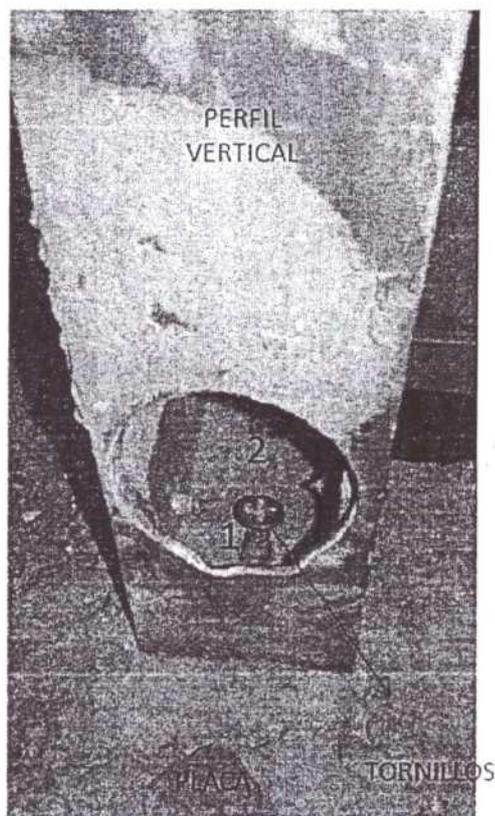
Sistema de Anclaje Utilizado para Conectar el Perfil Vertical con la Estructura de Concreto
